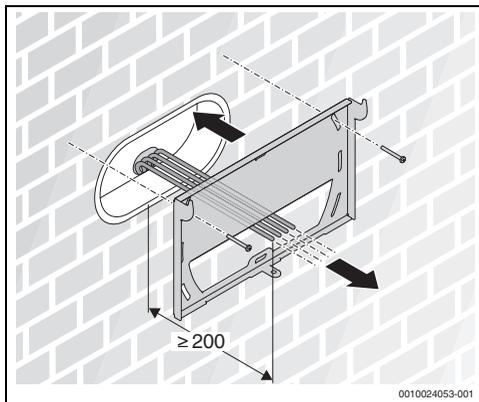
Installare il supporto a parete (dimensioni in mm)
